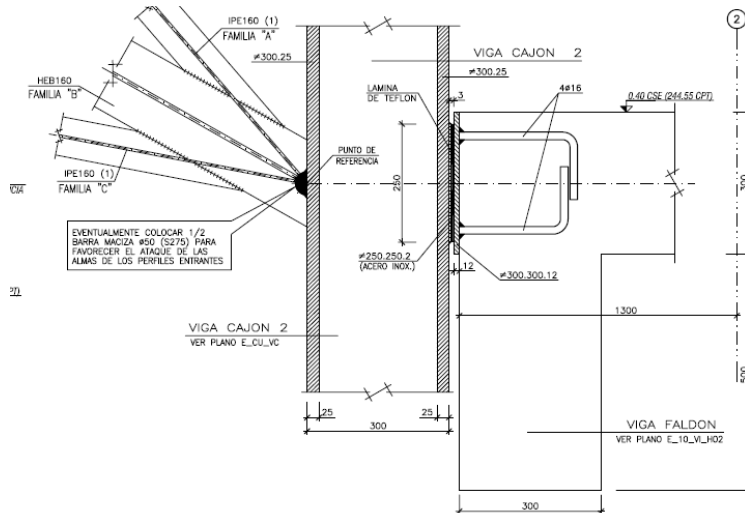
Apoyo deslizante de la viga cajón del mirador a nivel de penúltima planta.
